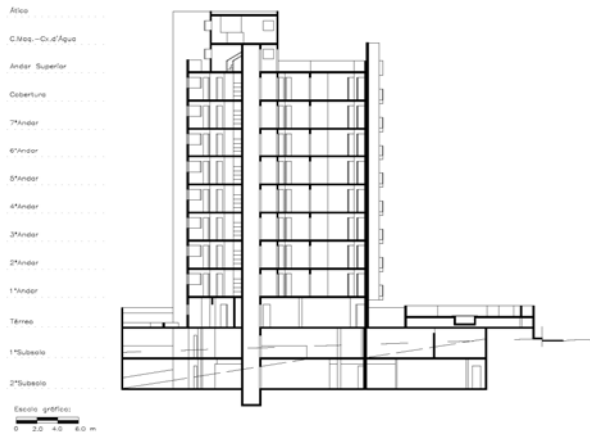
Planta digitalizada do corte longitudinal (2006)
